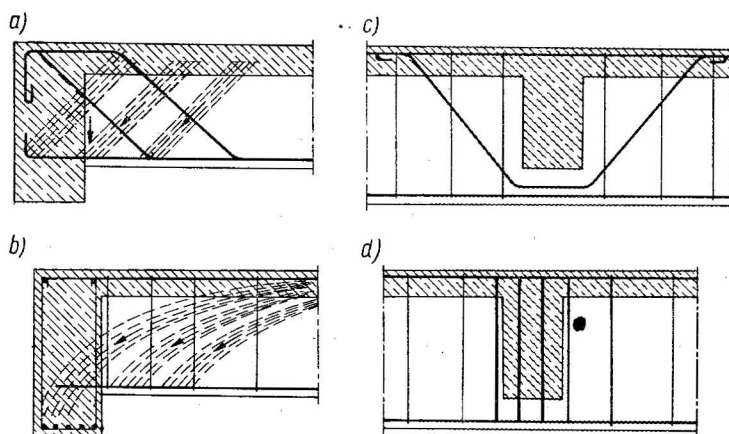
Transmission des efforts d'une nervure sur la poutre-maitresse et disposition de l'armature de la poutre-maitresse supportant la nervure, d'après LEONHARDT
